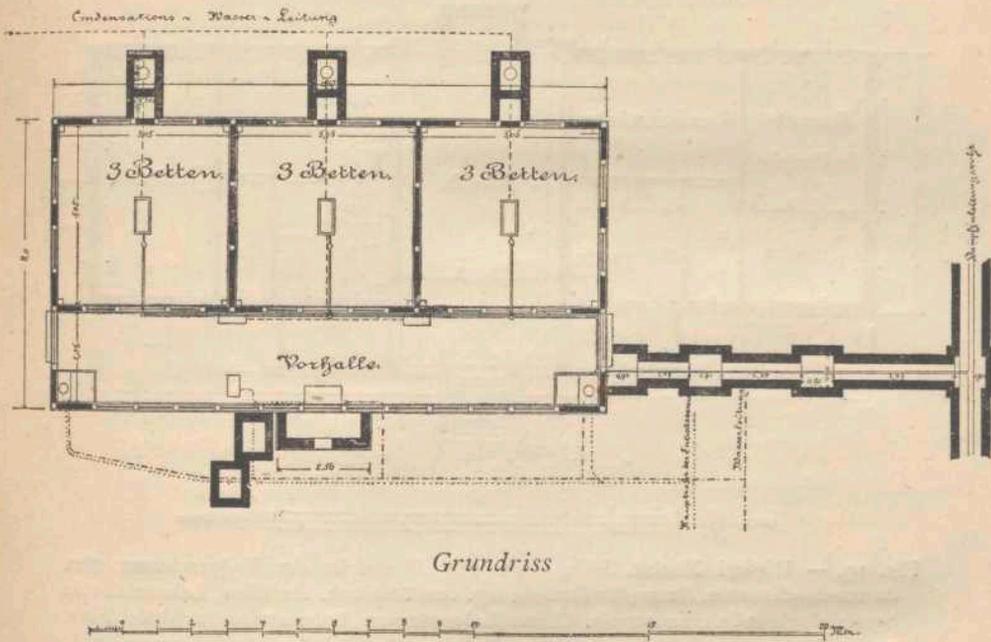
Le pavillon d'isolement. Grundriss, plan. 3 Betten, 3 lits. Vorhalle, promenoir. Dampfzuleitungsrohr, conduite de vapeur. Condensations Wasser Leitung, conduite des eaux de condensation.
